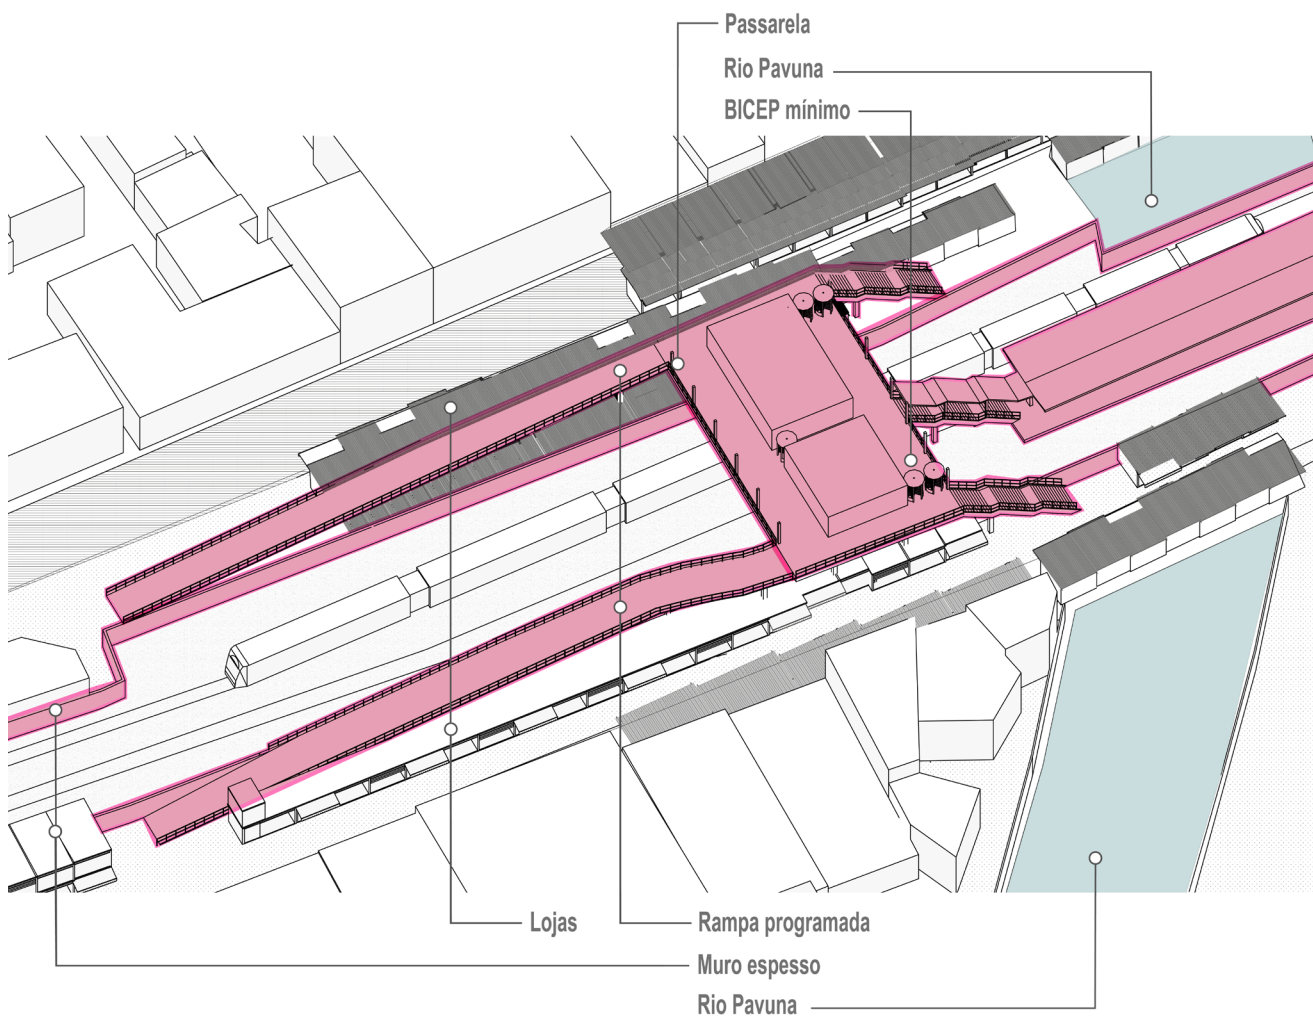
Axonometria da estação de trem Pavuna/São João de Meriti evidenciando seus elementos constituintes: rampa, escada, passarela, plataforma, muro espesso. Fonte: Elaborado pela autora (2024).
